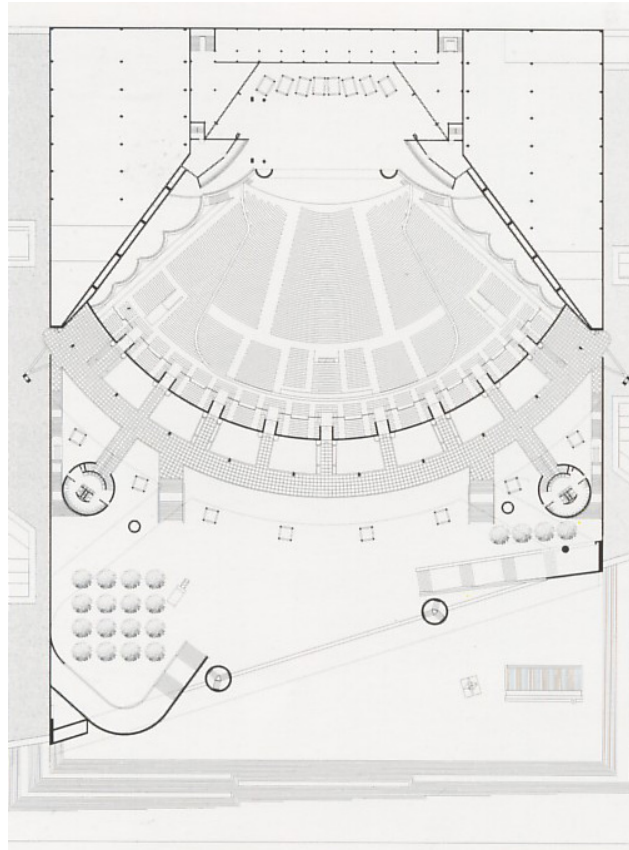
Planta arquitectónica del Auditorio Nacional.
